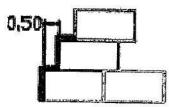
Perfil de muros tipo gaviones en margen derecho de sitio ocupado en la Quebrada Cuaré.
